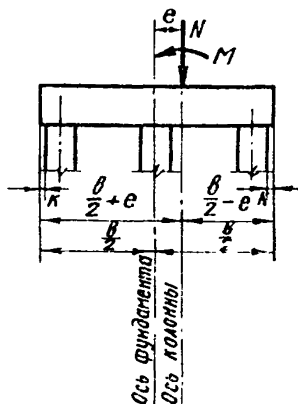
Схема смещения свайного фундамента относительно оси колонны на величину эксцентриситета.
